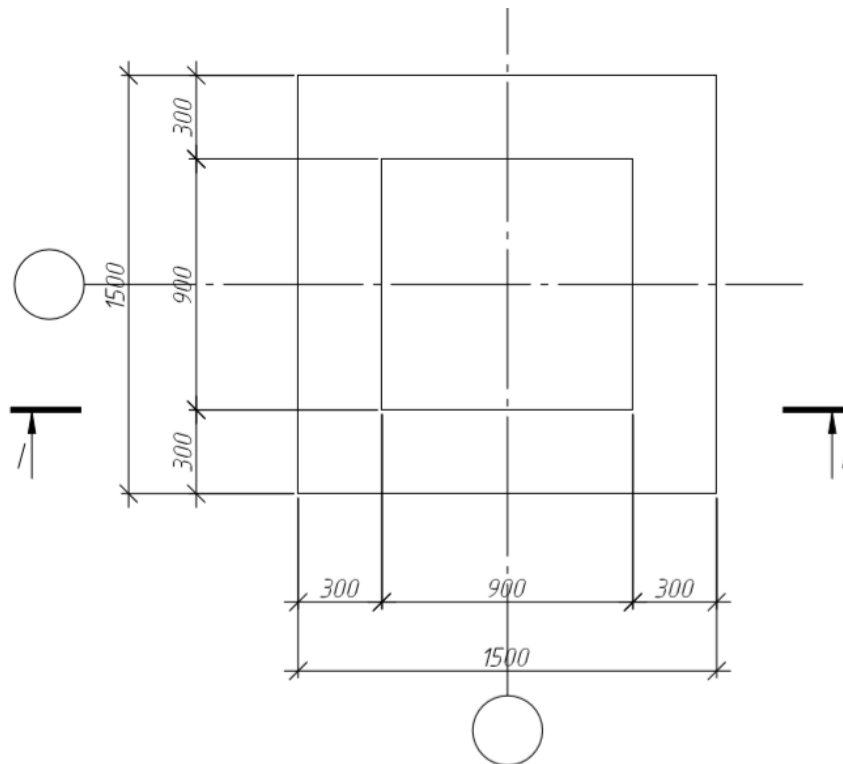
Схема сечений к расчету армирования подошвы фундамента
